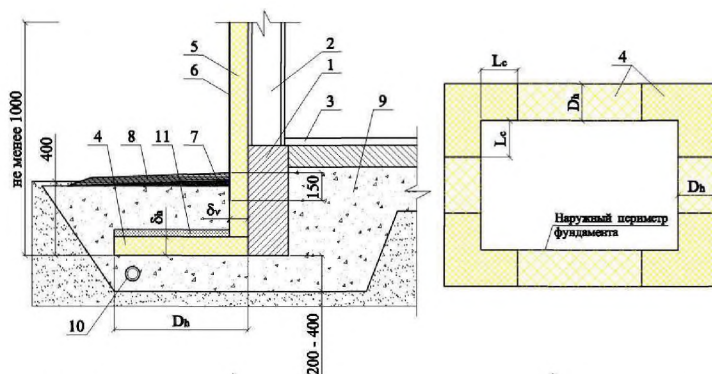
Схема укладки и параметры теплоизоляции в фундаментах отапливаемых зданий без теплоизоляции пола для общественных и производственных зданий
